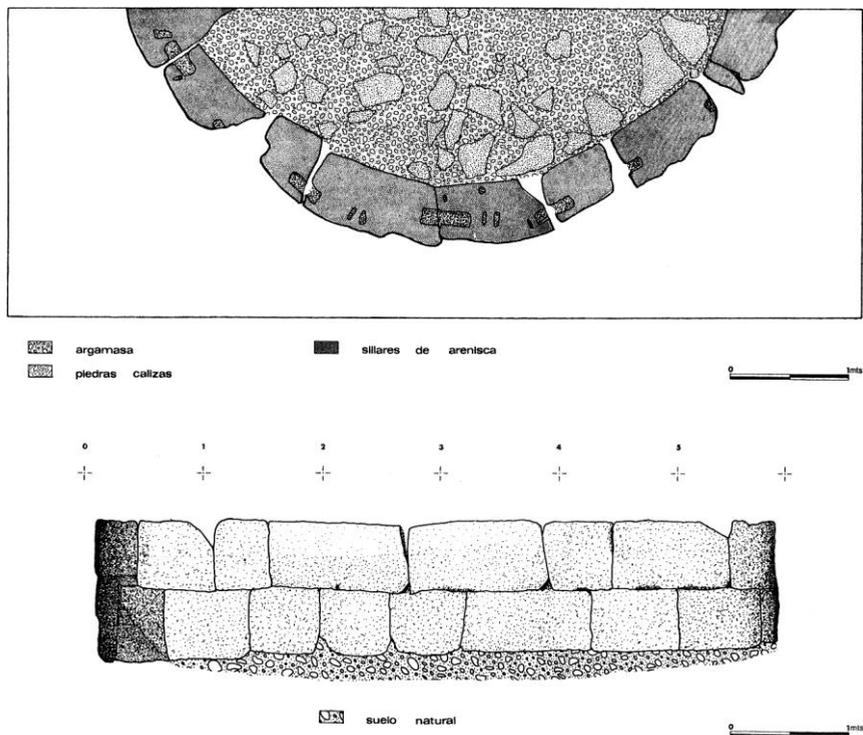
Planta y alzado del cubo excavado en 1978 (Argente, 1980).
